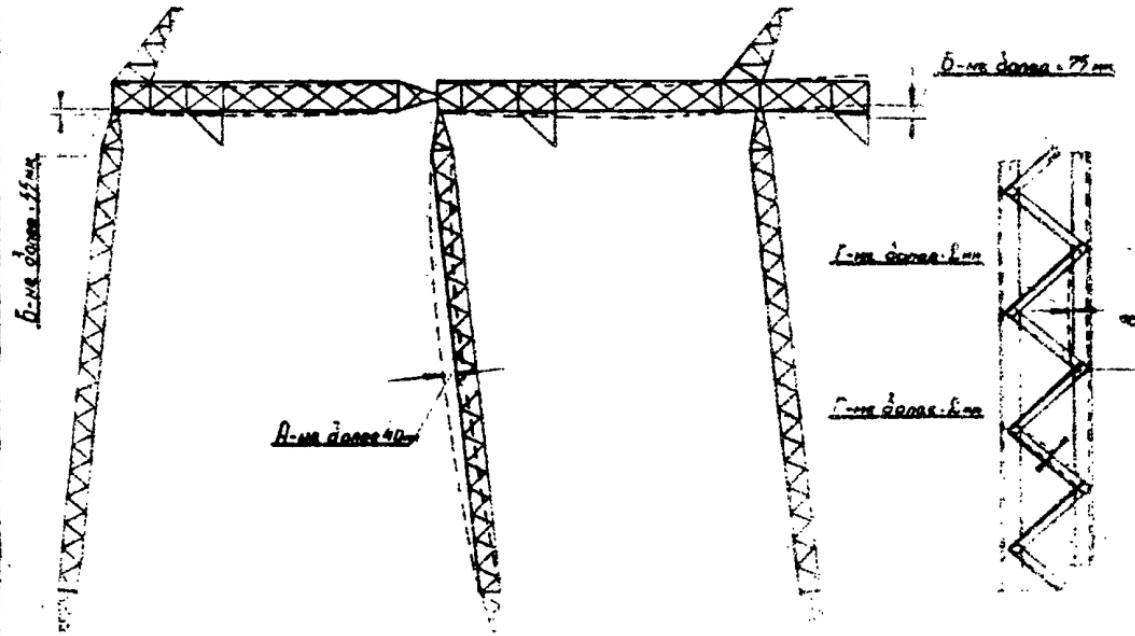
Допуски на сборку опоры ПЧБР6
